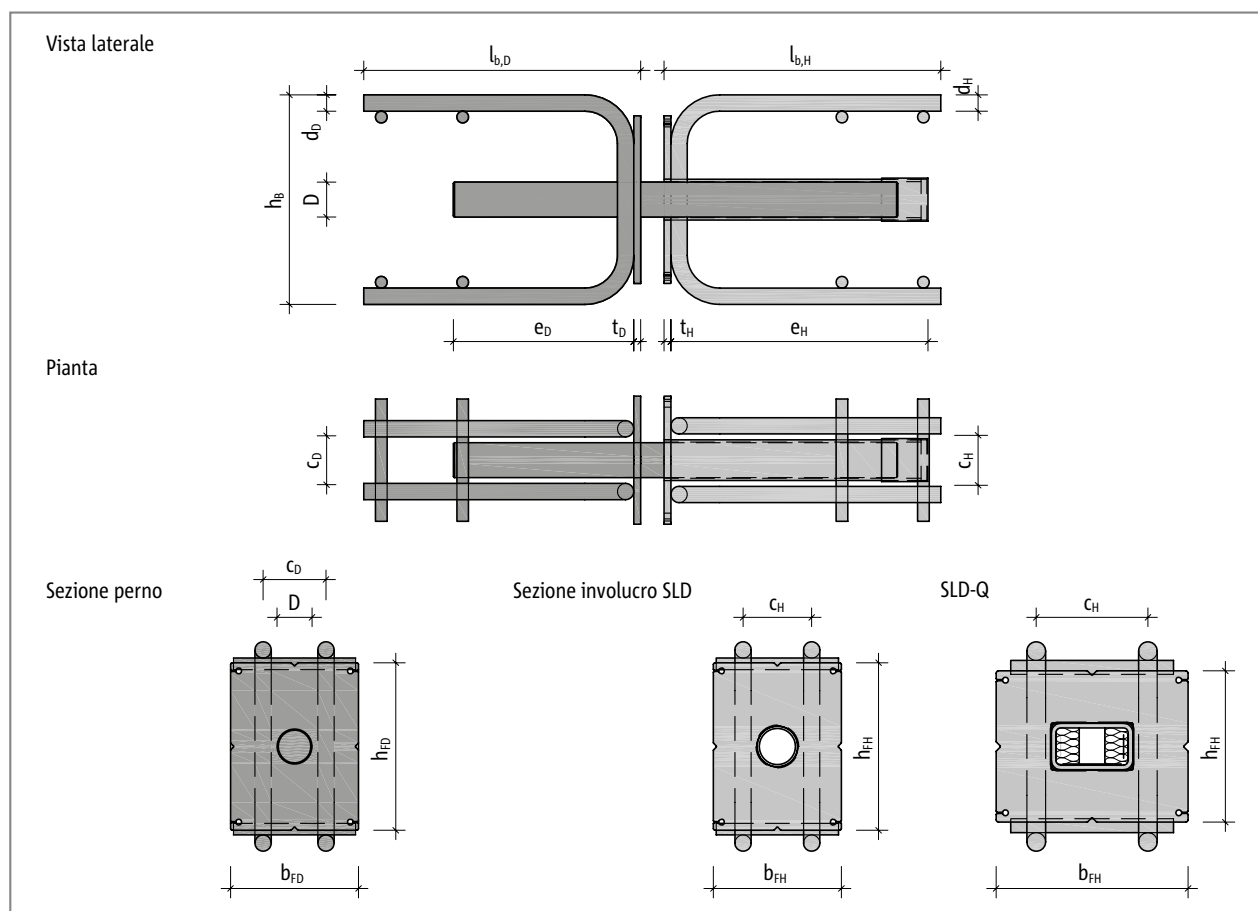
Schöck Dorn tipo da SLD 40 a SLD 80: dimensioni
